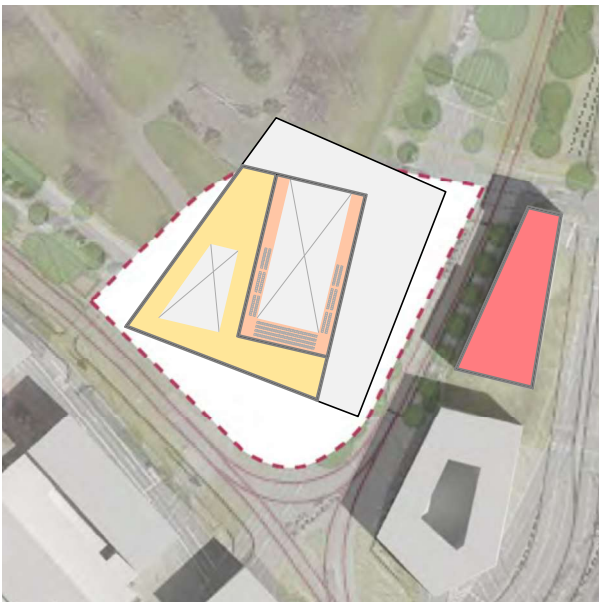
Grundriss OG2 Bahnhofsquartier V2
